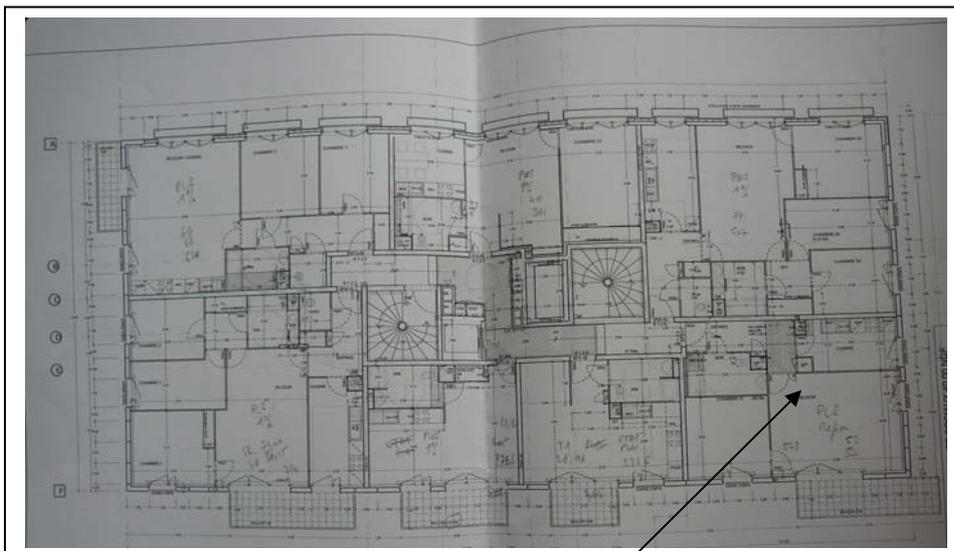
Plan d'étage B3g : tourette ouest et retour ouest du bâtiment principal : logements sociaux.
